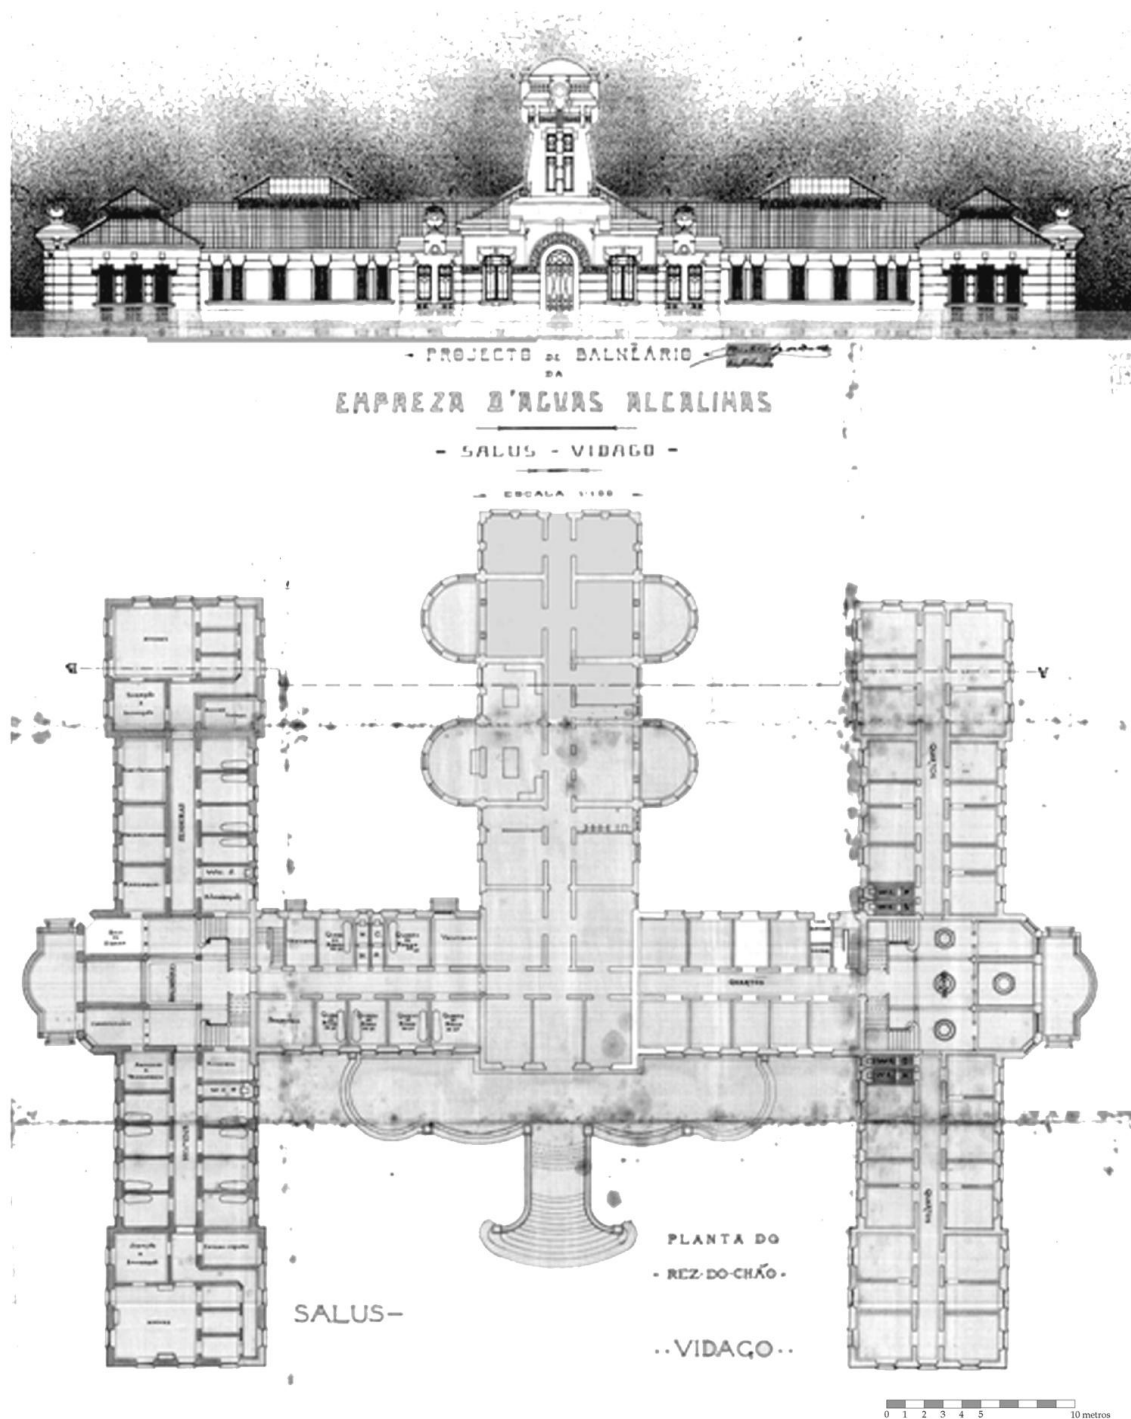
Projecto do Balneário – Alçado e planta piso 0 (1914).
